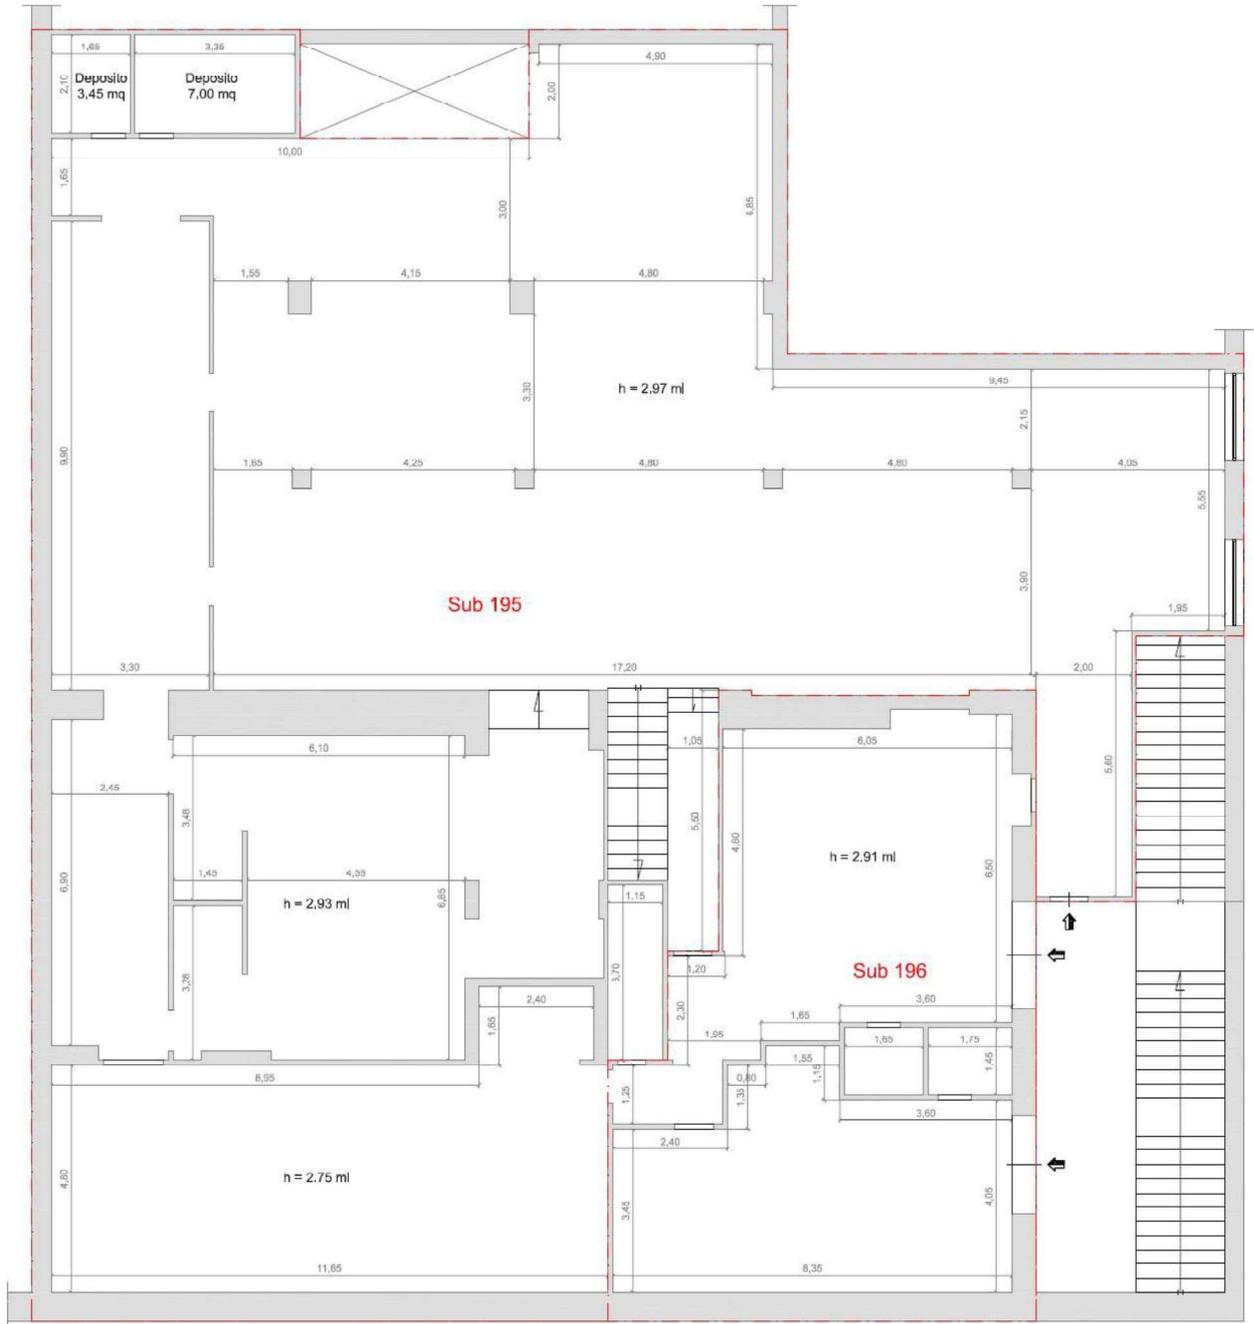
Planimetria Catastale Attuale, Piano Seminterrato, Foglio 48, p.lla 76, Sub 195-196 (Ex Sub 1).
